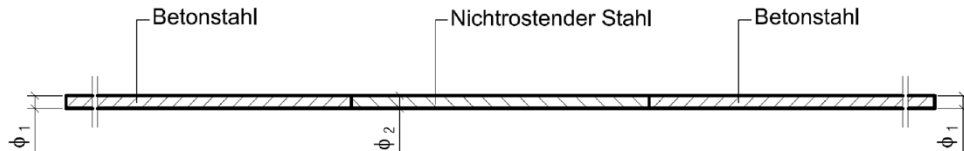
Druckelement aus Stahl mit beidseitig angeschweißtem Betonstahl
